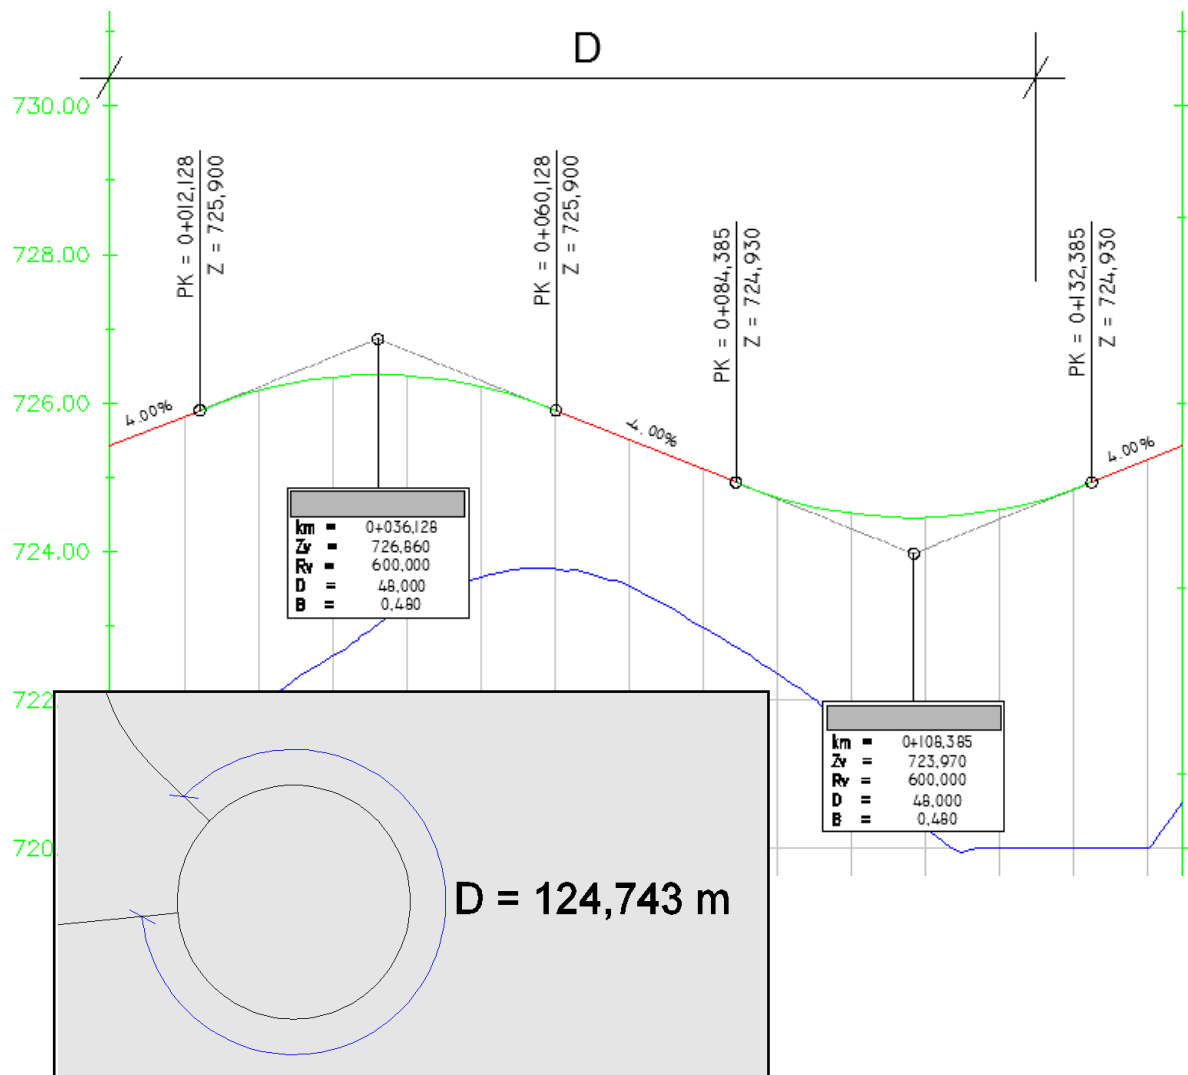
Perfil Longitudinal da rotunda B. Esquema da extracção da cota de intersecção do ramo A com a rotunda B
